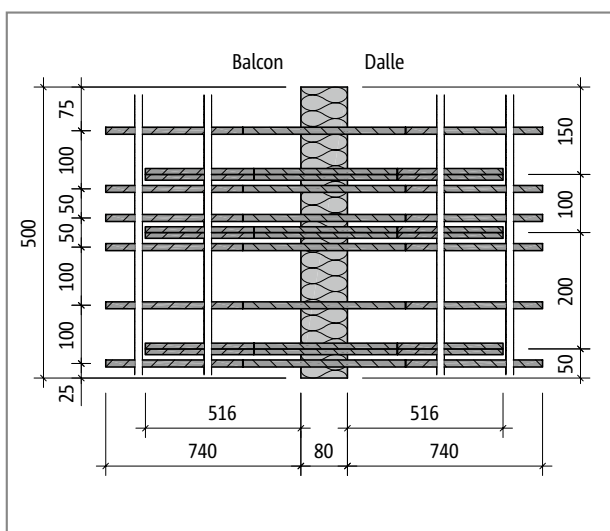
Schöck Isokorb® T Type D-MM5-VV3 en longueur L500 : Plan de base
